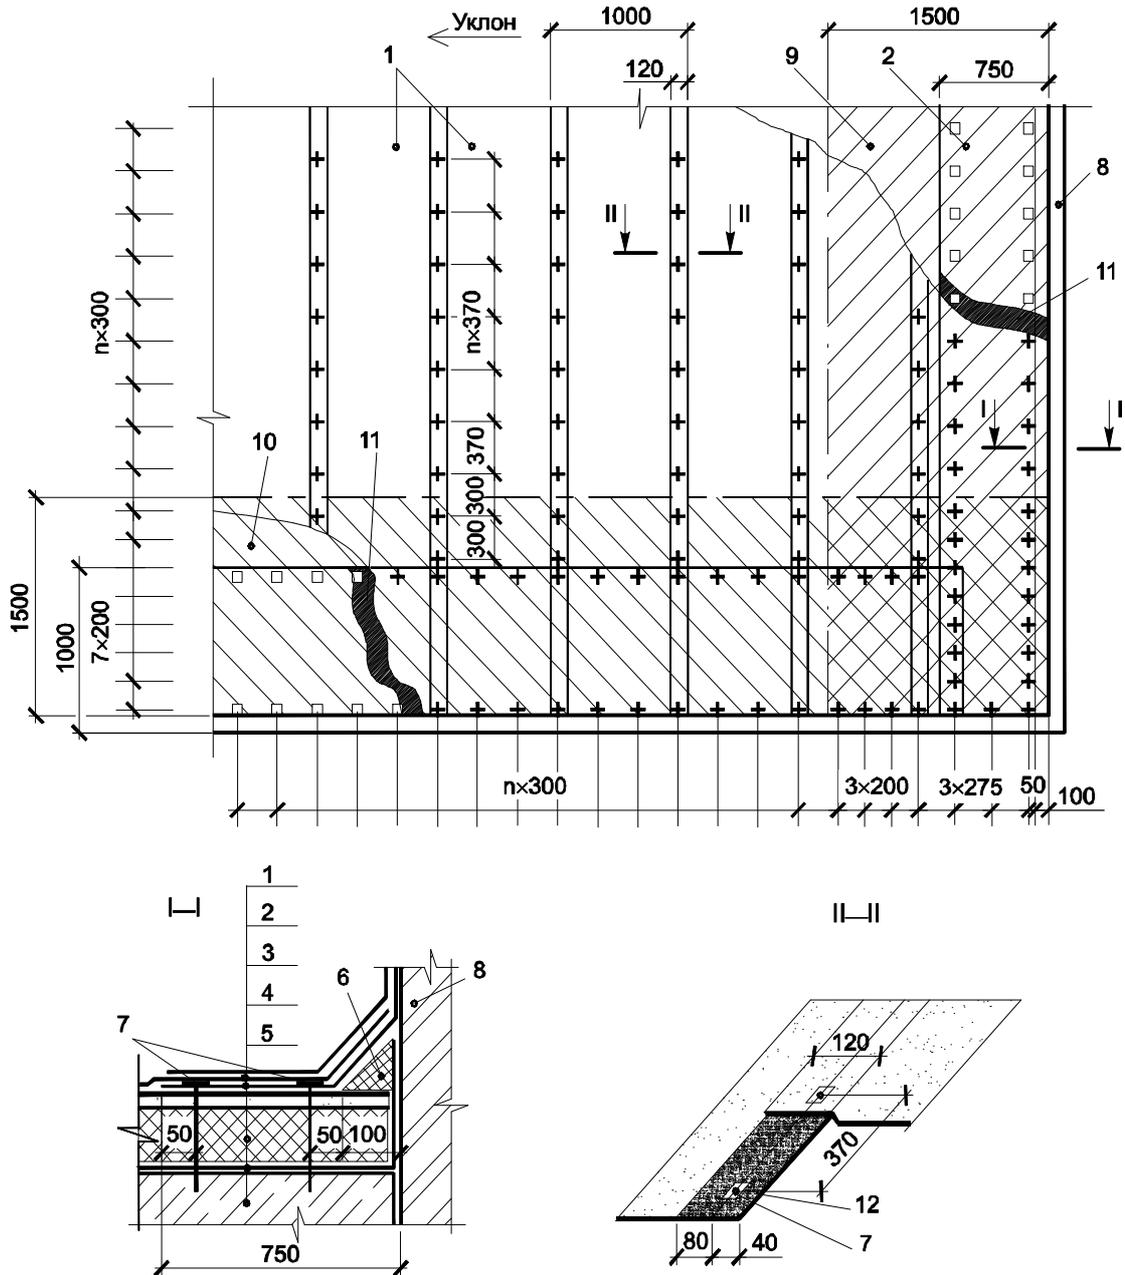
Схема закрепления нижнего слоя водоизоляционного ковра по основанию из деревянных элементов при уклоне кровли не более 10 %
